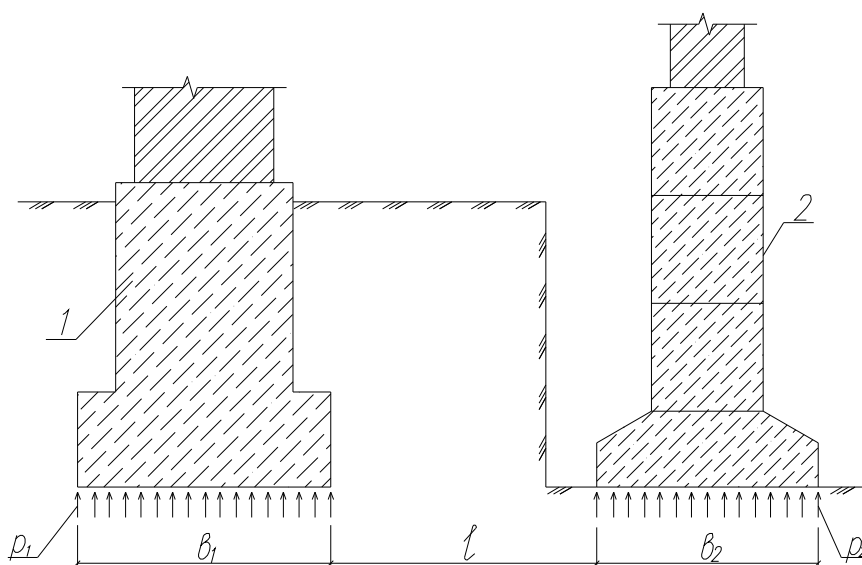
Примыкание фундаментов к существующему зданию при одинаковой глубине заложения подошвы
